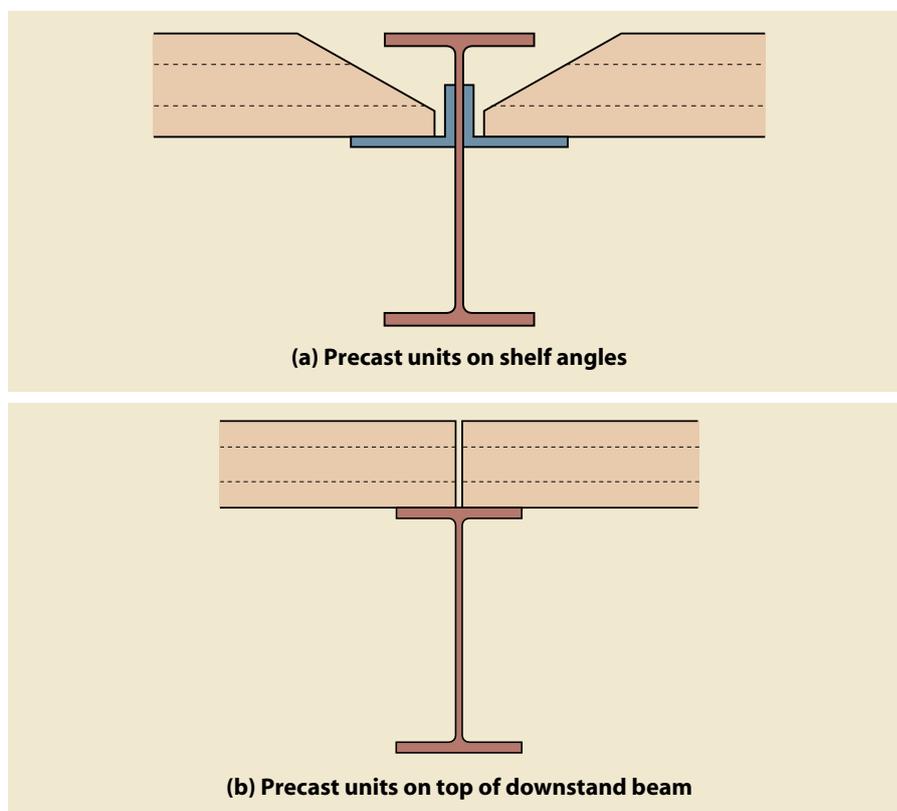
Detalles de forjados con placas prefabricadas de hormigón con acción no mixta
